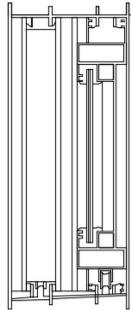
Detalle carpintería de aluminio. Fuente: Propia de la autora
